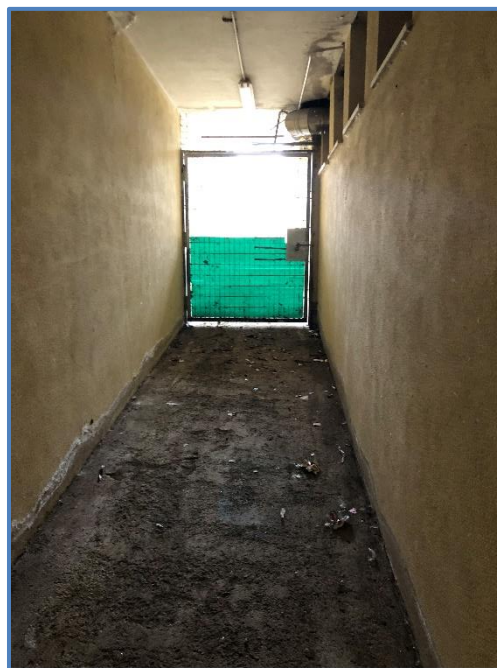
65 - ingresso dall'esterno al piano interrato, lato bar - ristorante
